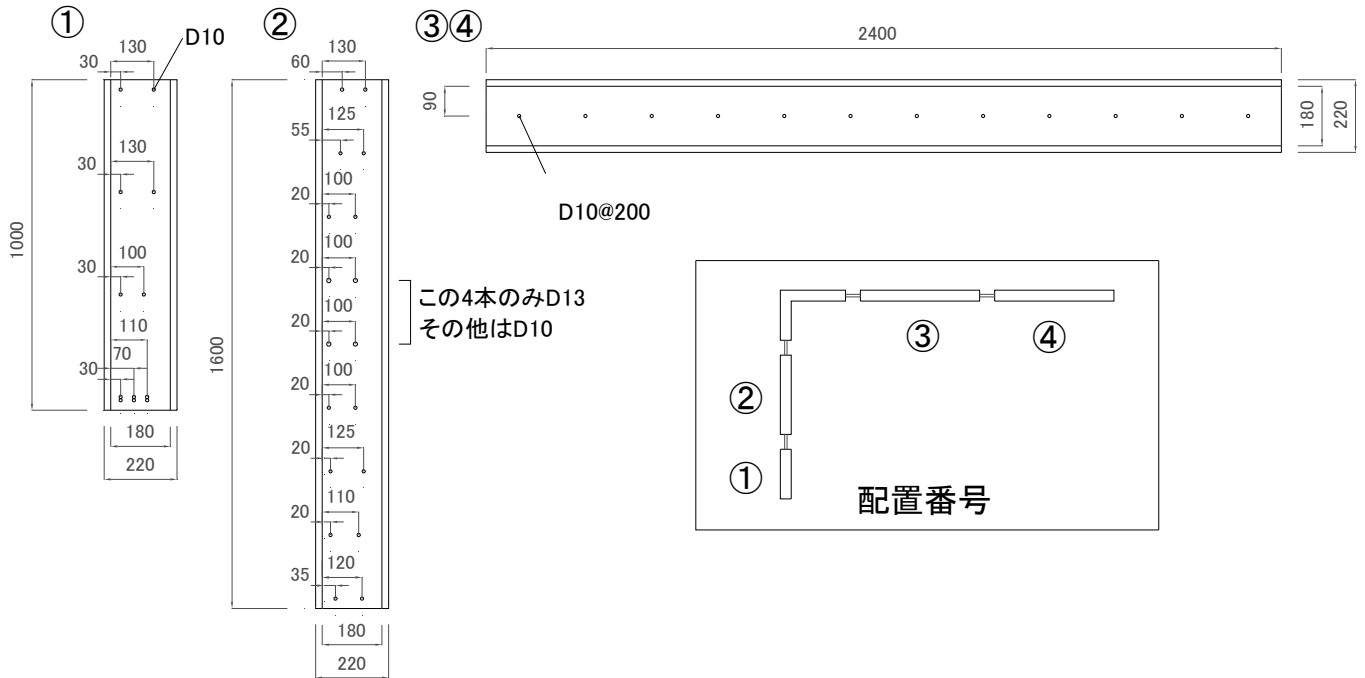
RC 塀の平面図・断面図 (単位: mm)
